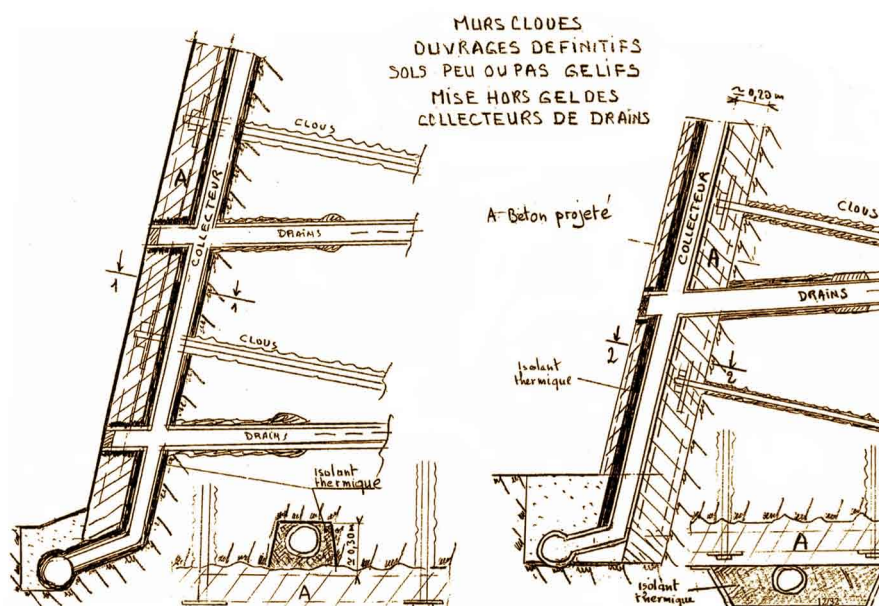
Exemples de mise hors gel d'extrémité de drains subhorizontaux (D'après document SETEC)
